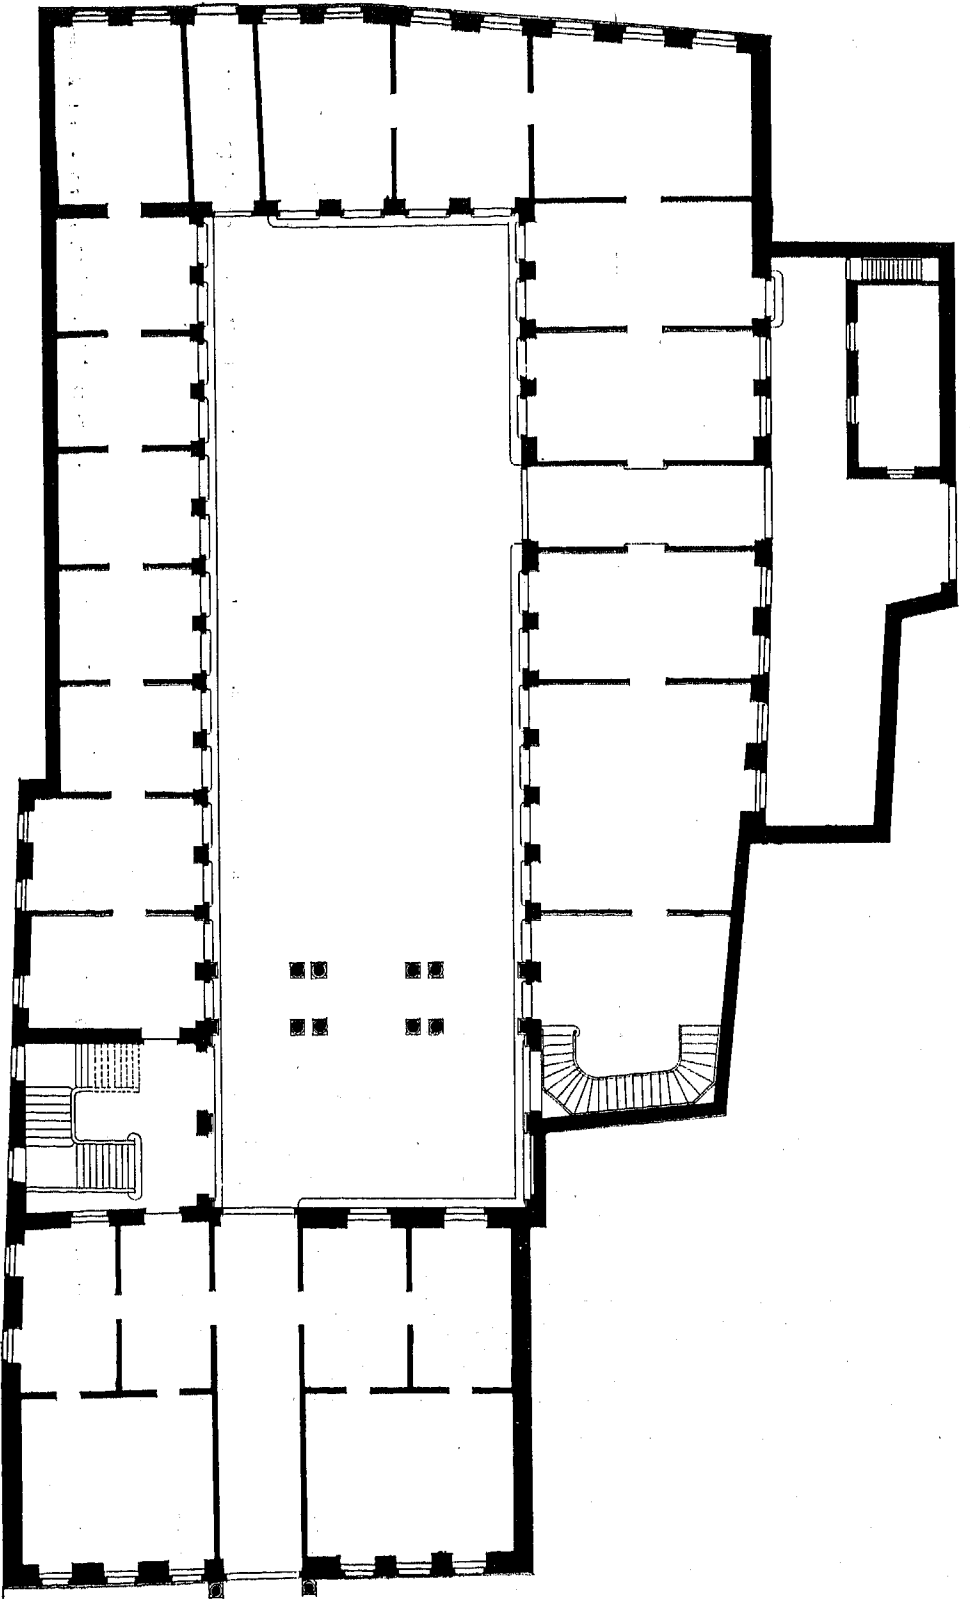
Grosser Braunfels, Grundriss des Erdgeschosses; nach den Akten des Bau-Amtes.
